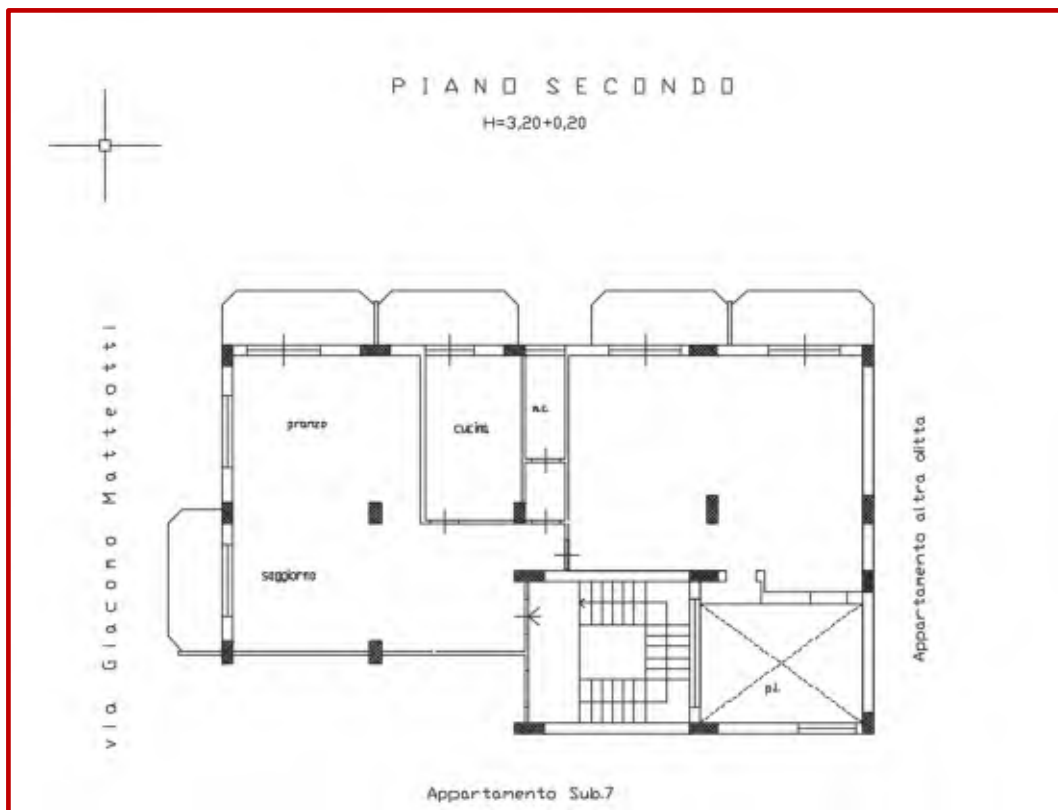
Planimetria aggiornata secondo il reale stato dei luoghi fg. 18 part. 974 sub 6 piano secondo Via G. Matteotti
